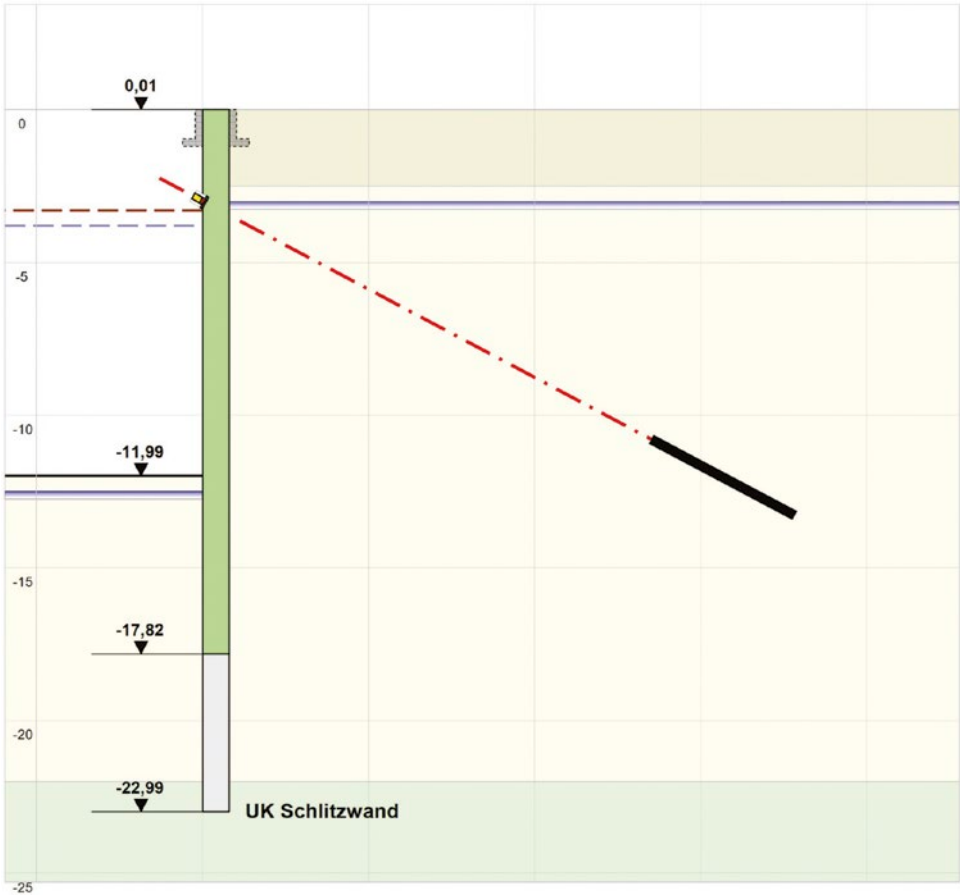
Darstellung Baugrubensituation – Ortbetonschlitzwand mit einer Ankerlage (Quelle: BAUER Spezialtiefbau GmbH)
